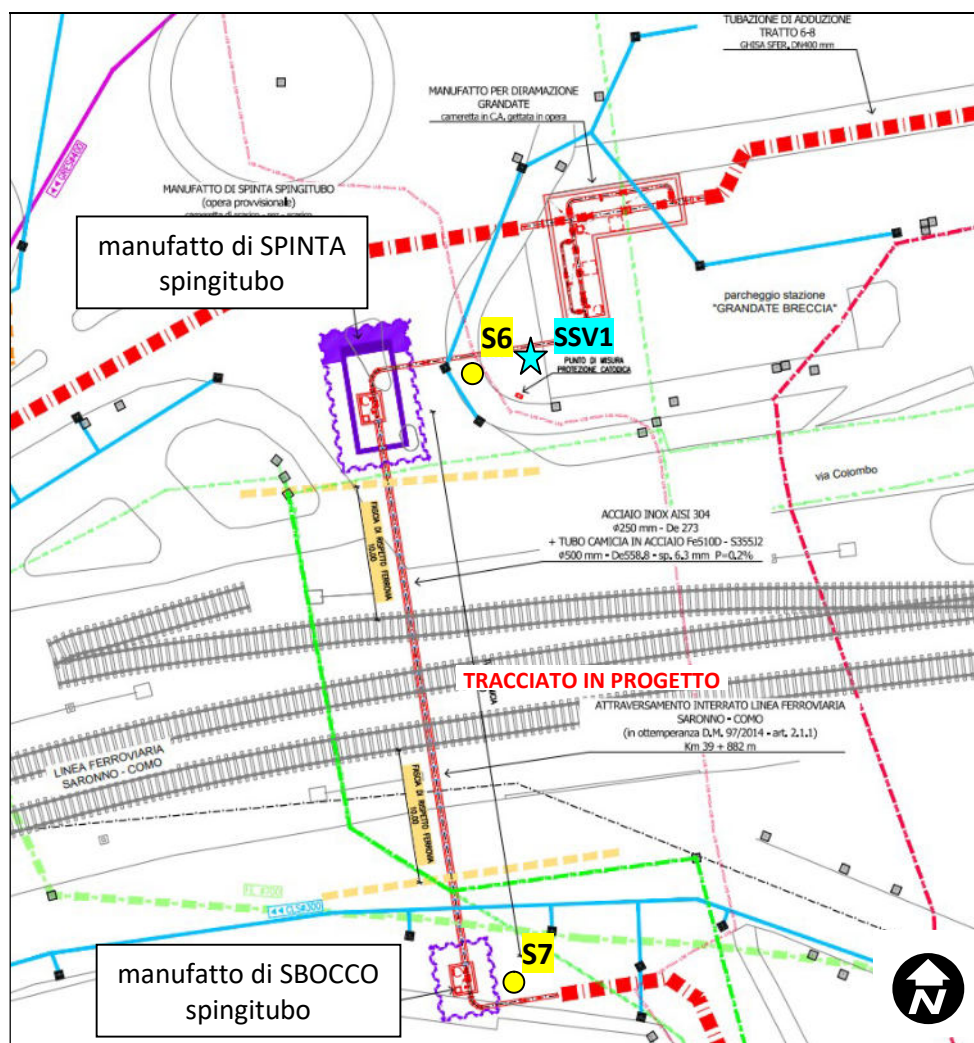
Planimetria di progetto attraversamento ferroviario (non in scala)
